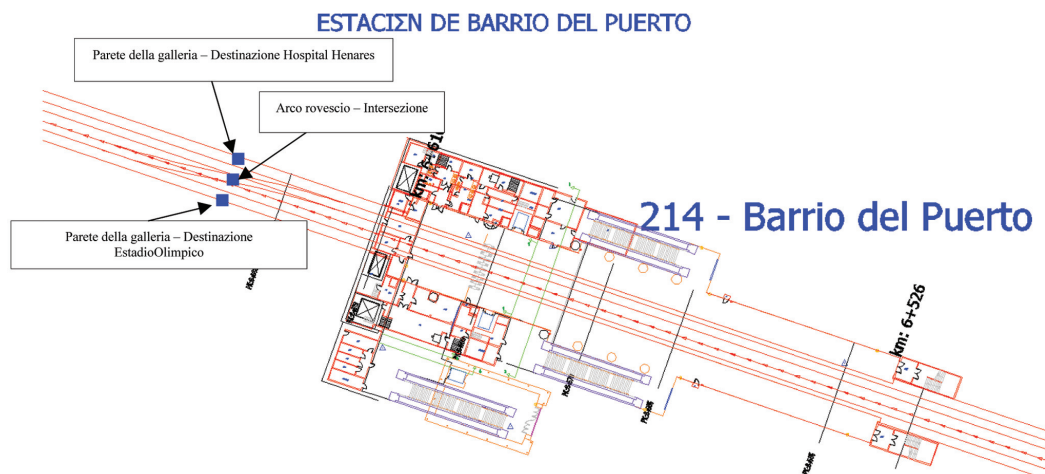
Schema dei punti di misurazione nella Metro di Madrid (Barrio del Puerto). *Measurement's locations layout at Madrid Metro (Barrio del Puerto)
